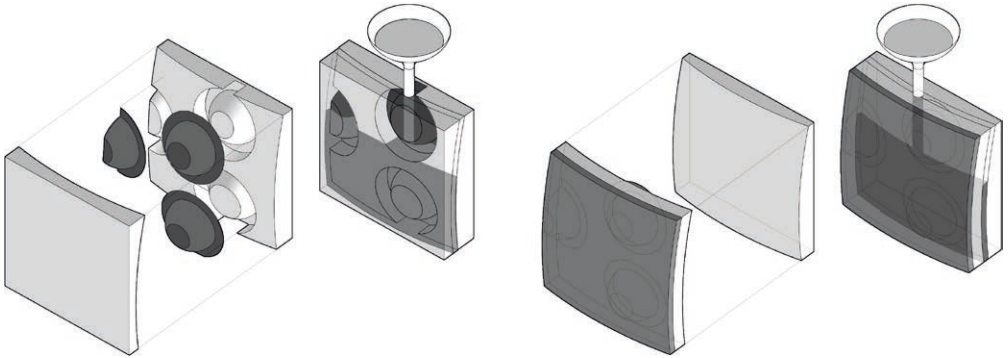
Einfach gekrümmtes Sandwich mit innenliegender Dämmung und stabförmiger Schubbewehrung mit C-Profil (links) und doppelt gekrümmtes Sandwich mit halbkugelförmiger Schubbewehrung (rechts) | Fig. 1: Single-curved sandwich with internal insulation and bar-shaped shear reinforcement in C-profile (on the left) and doubly-curved sandwich with hemispherical shear reinforcement (right side) | Source: Gabriela Metzger, Oliver Gericke, [1]
